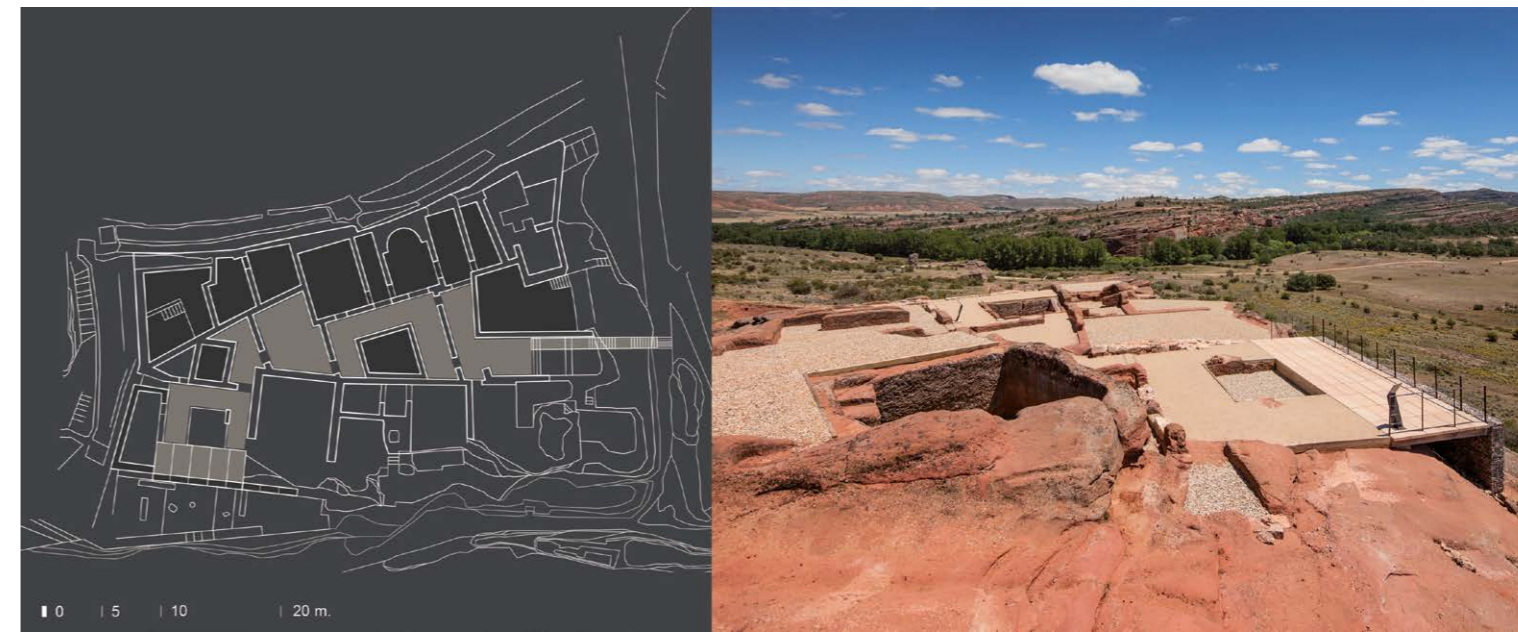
Tíermes. Casa del Acueducto. Planta de proyecto y vista general. Fotografía: Paulo Paiva.
